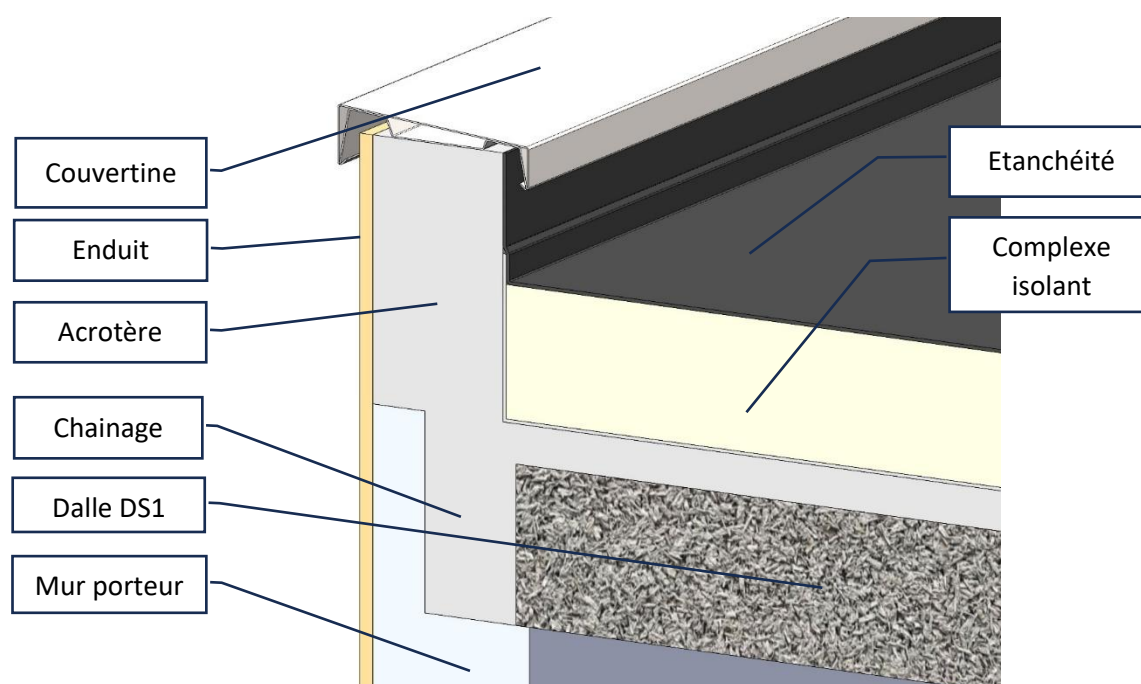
Exemple de traitement de l'étanchéité d'une toiture terrasse DS1 avec acrotère bas
